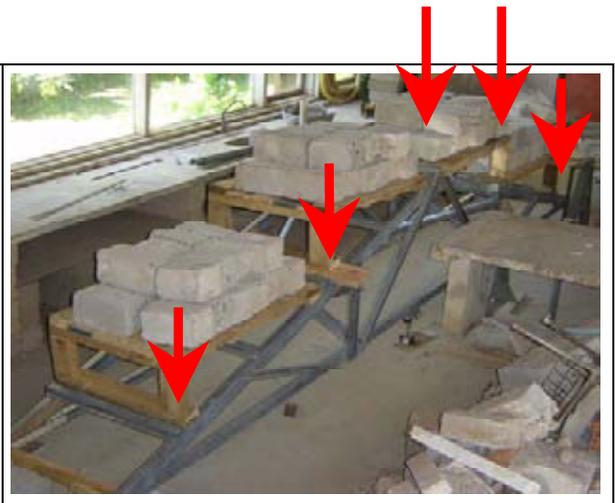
ensayo practicado a modulo de cerchas reforzado
